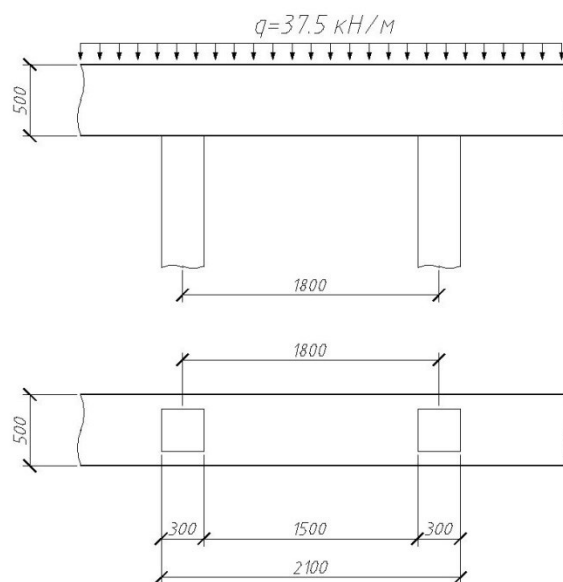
Схема расположения свай под стены цокольного этажа.
